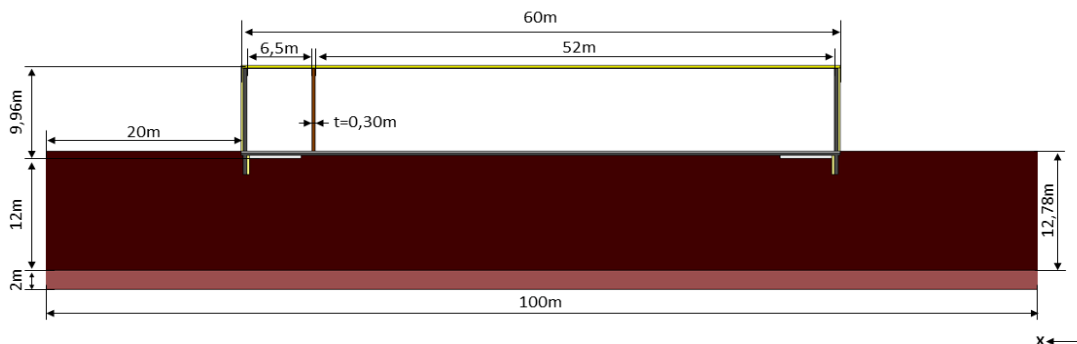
X-Z Schnitt Gebäudevariante 5, 6m Horizontale Randdämmung, 2 m vertikale Randdämmung
